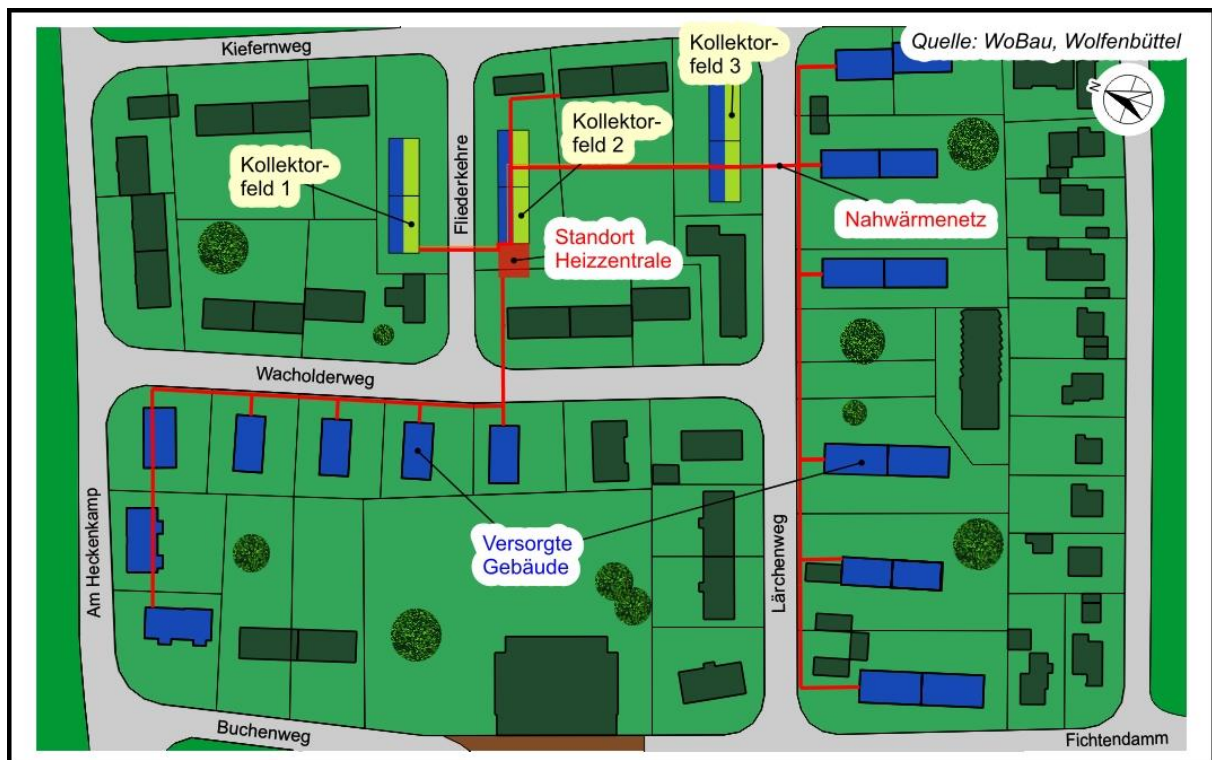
Lageplan Wolfenbüttel, Wohngebiet Ahlumer Siedlung
